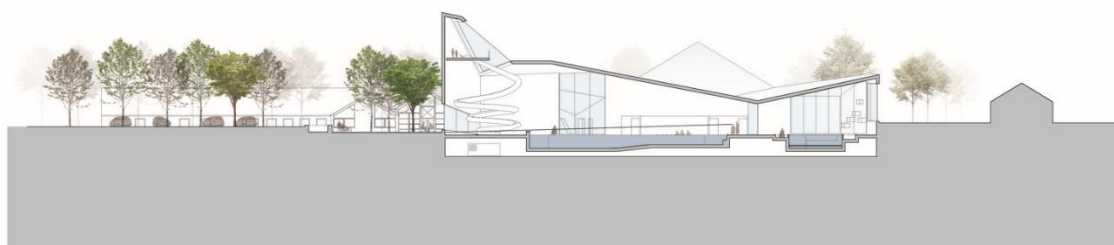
Розріз 2-2 «Vandhalla» [3]
